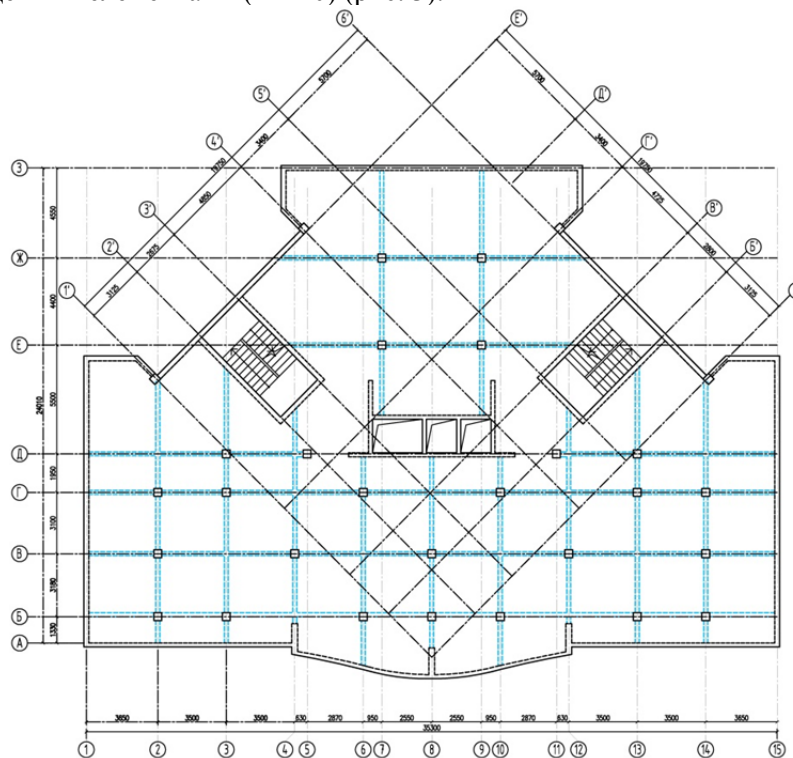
Конструктивна схема перекриття типового поверху будівлі
